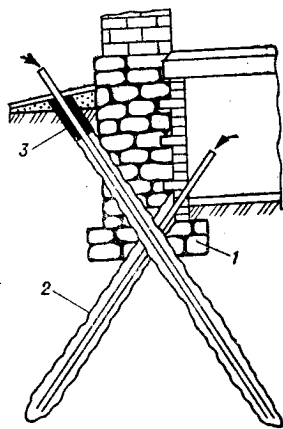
Буроін'єкційні палі для посилення існуючого фундаменту:
